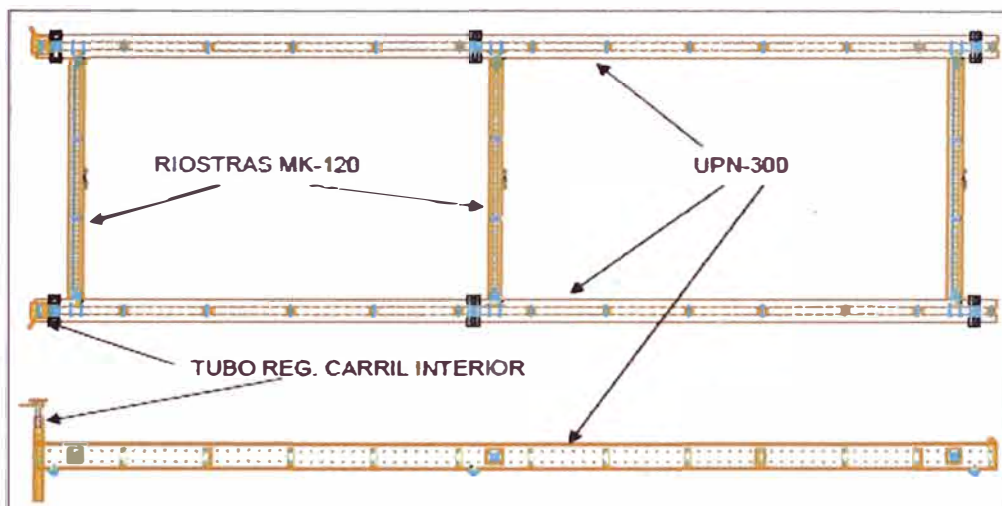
Vista planta y elevación de carriles de desplazamiento.
